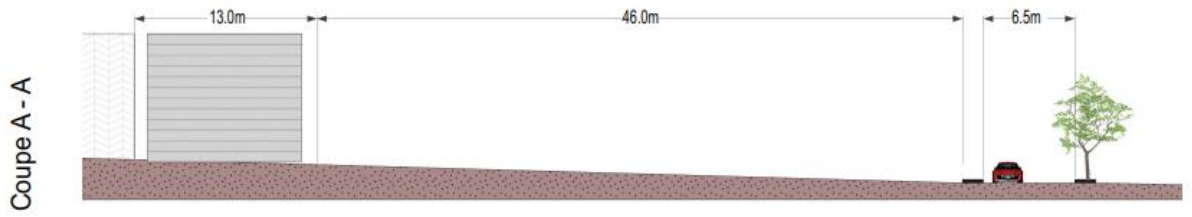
Coupe A-A représente la façade urbaine du site d'intervention
